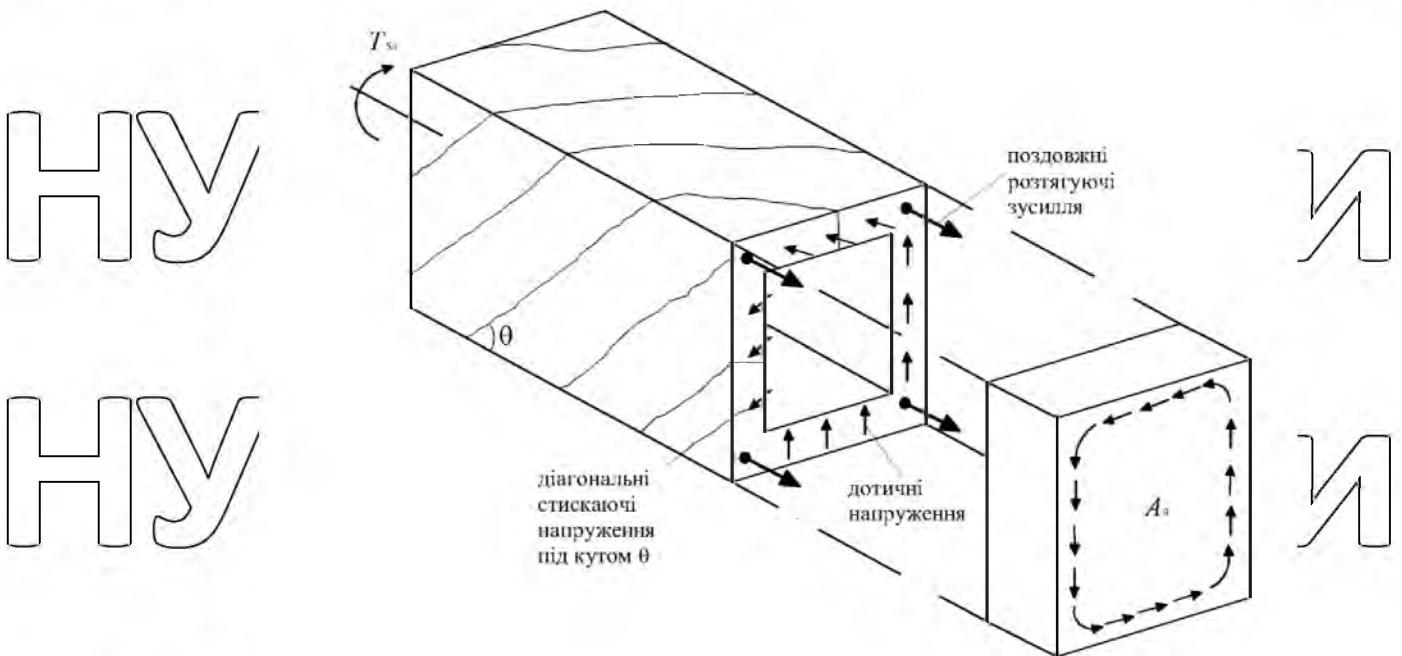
До розрахунку міцності залізобетонних елементів при крученні за методом тонкостінної труби [69,30]
